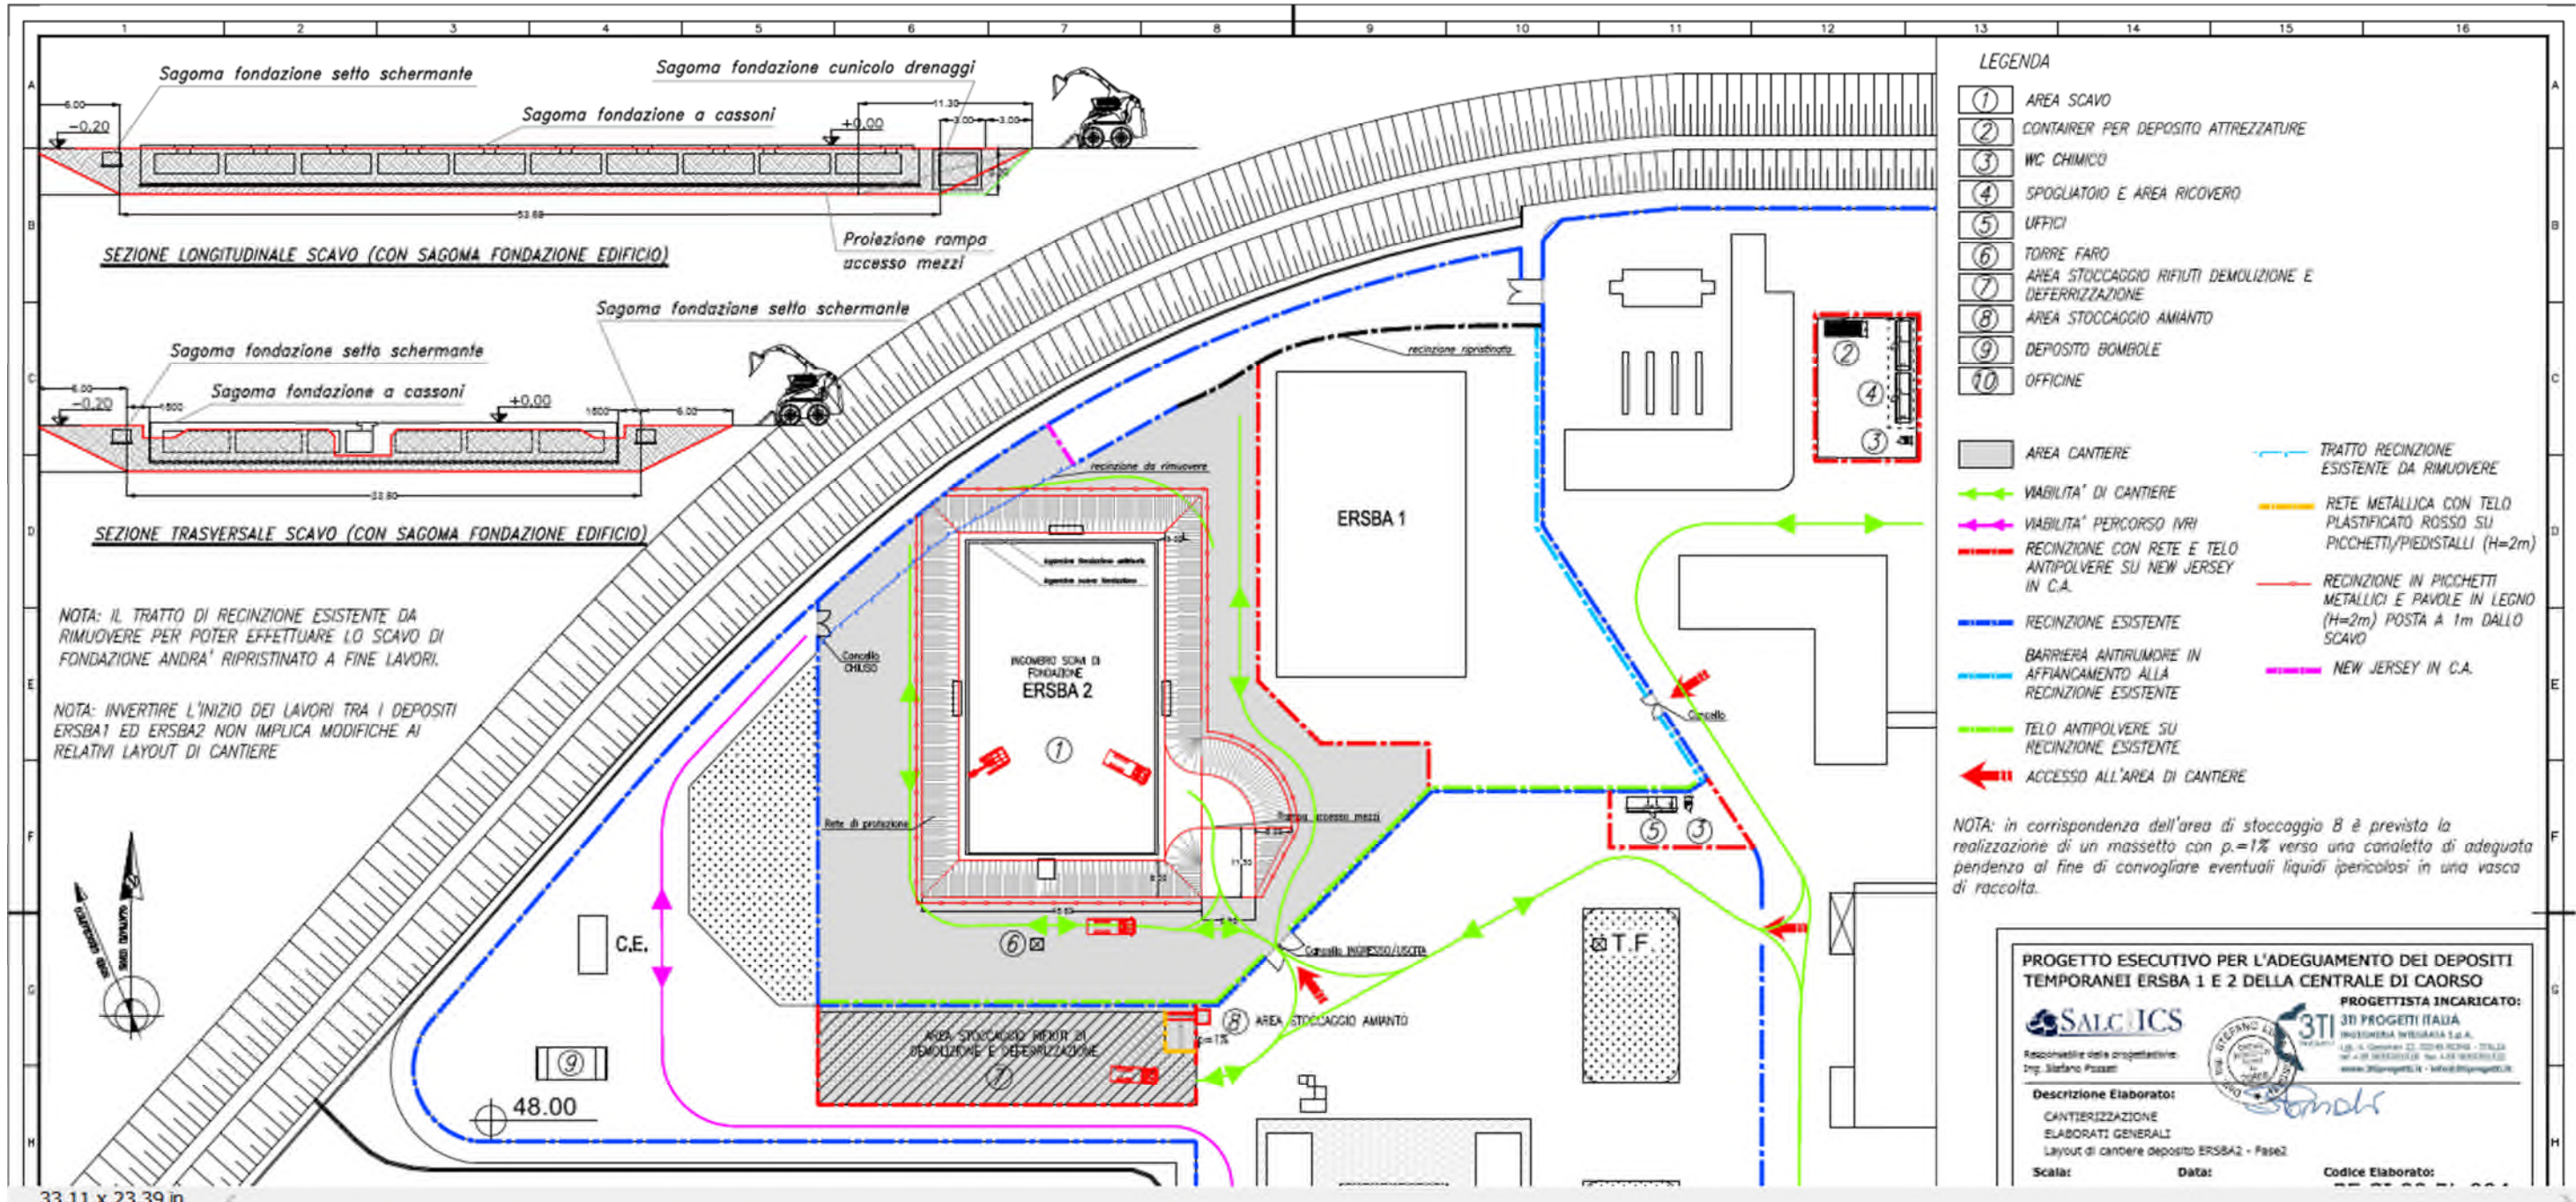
Planimetria generale della centrale di Caorso con l'indicazione dell'area di scavo del deposito ERBSA2
